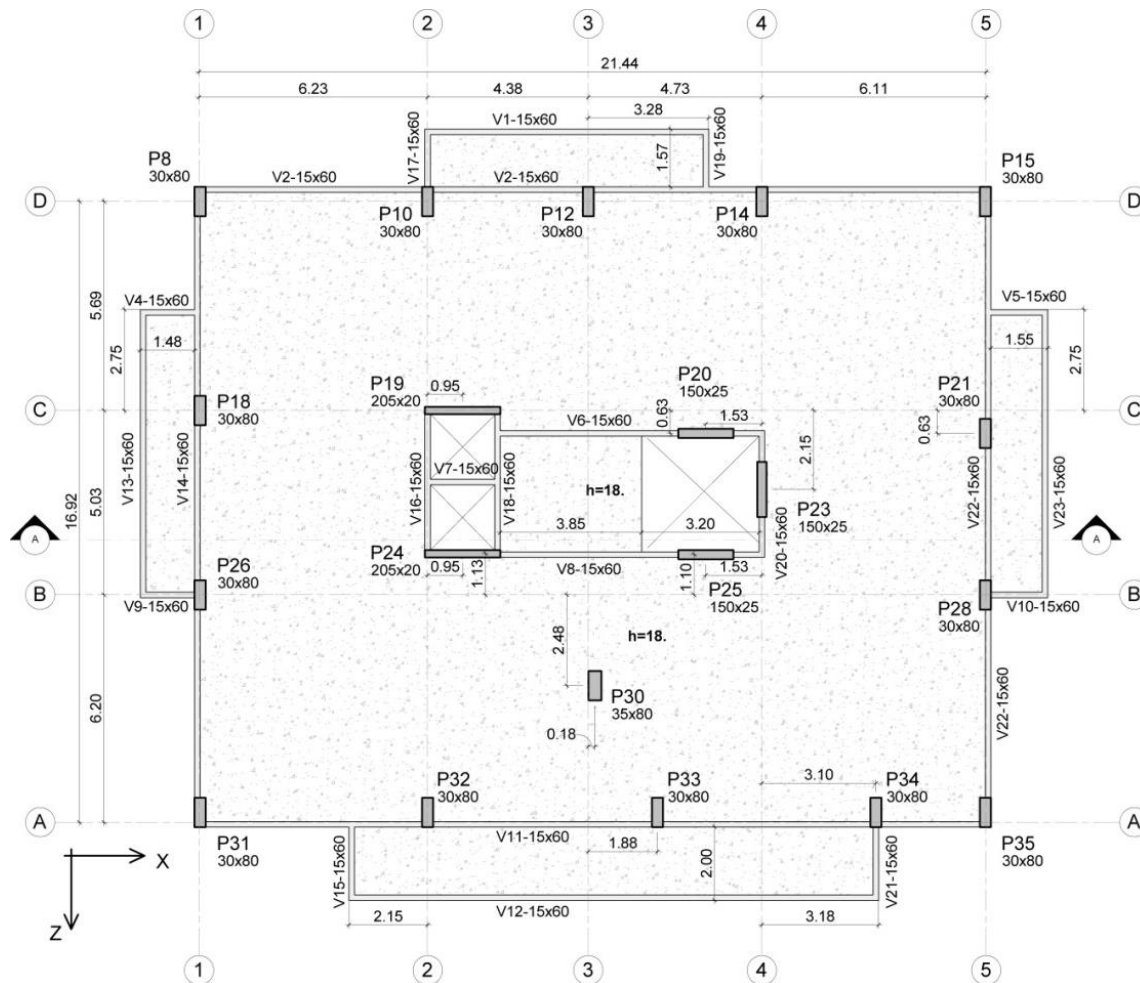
Planta estrutural - Modelos A e B - Unidades em metro
